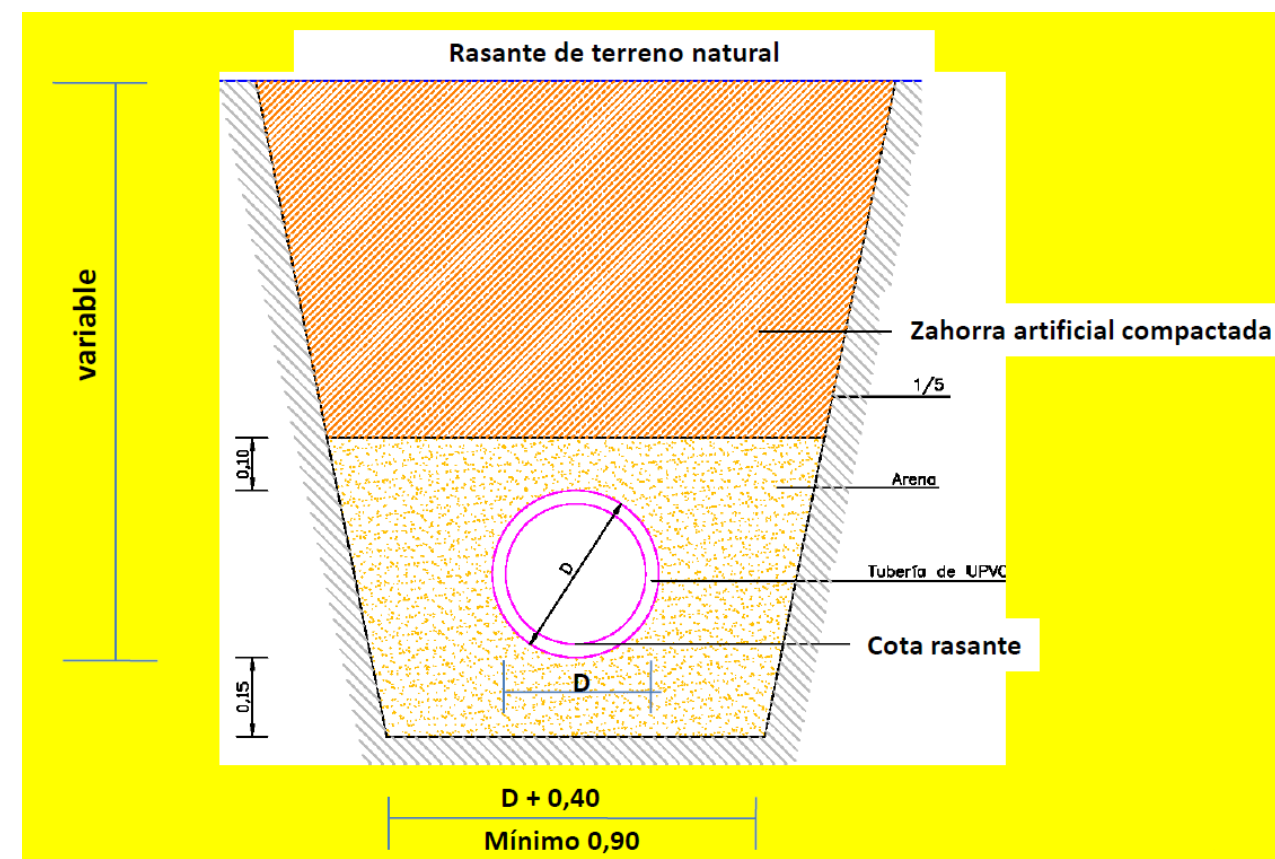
Sección tipo zanja con rasante de terreno natural
